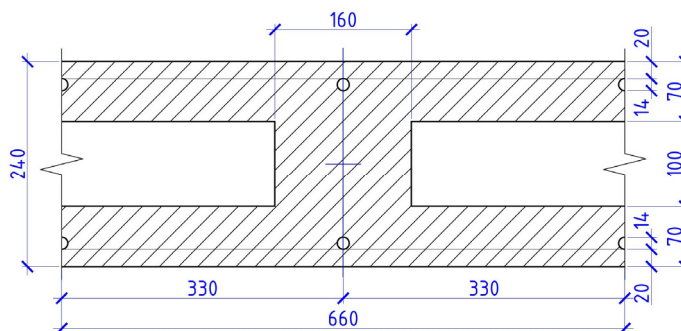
Разрез 3-го варианта перекрытия – плиты 240 мм
